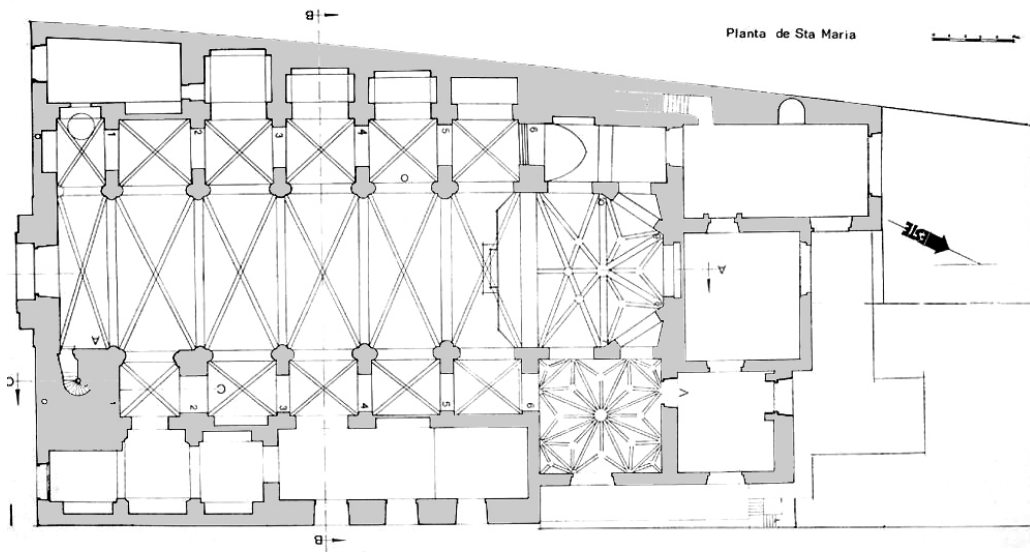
Pianta della chiesa parrocchiale di Santa Maria, Alicante. XV-XVI secolo¹⁹
